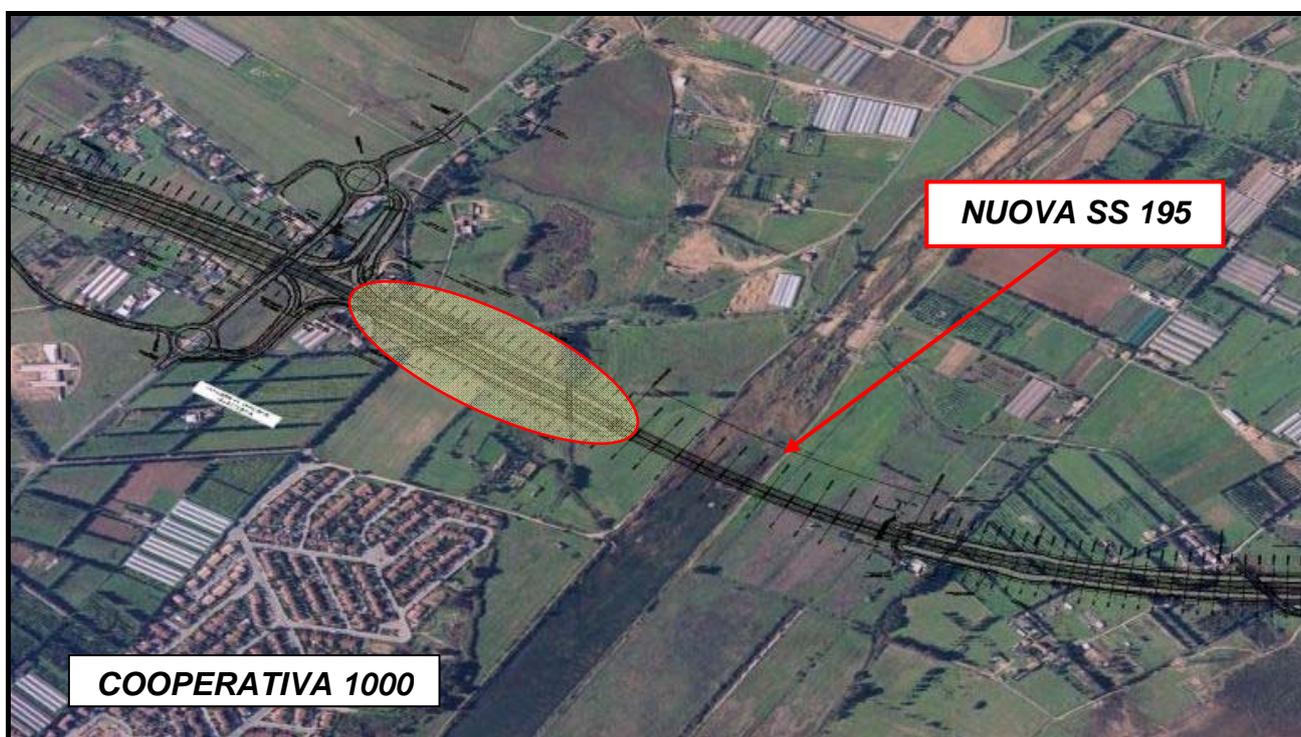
Stralcio del Lotto 1 della Nuova SS195. In evidenza il tratto di rilevato oggetto di riutilizzo (fonte: www.glf.it).
